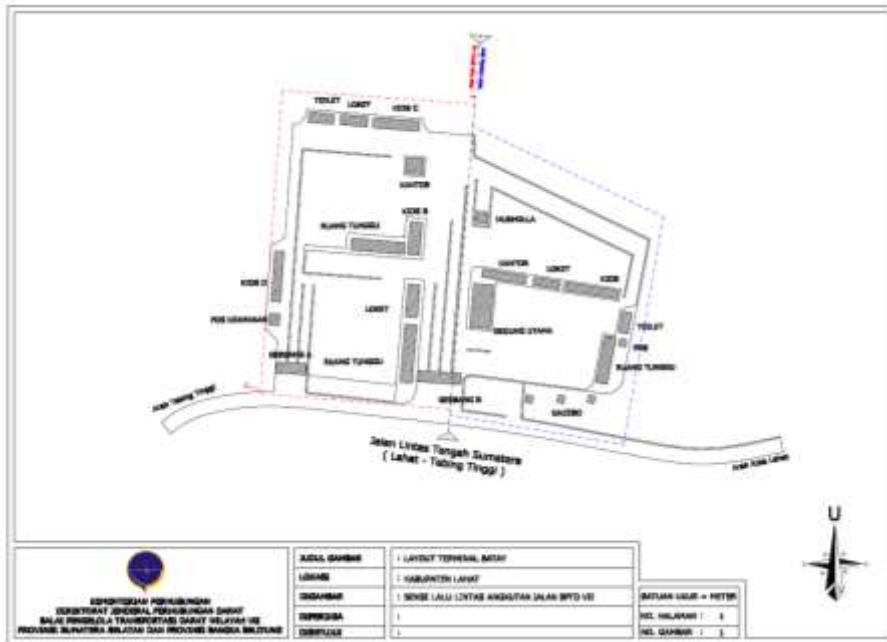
Desain layout Terminal Tipe A Batu Kuning
